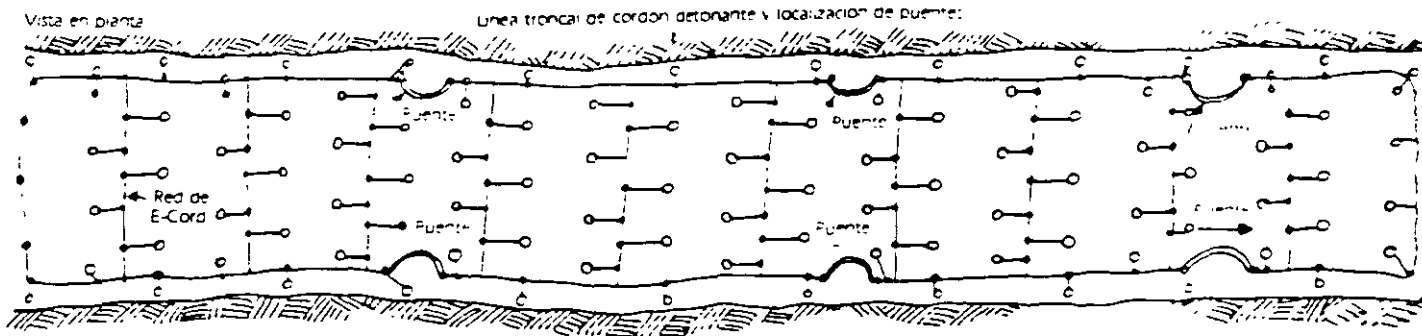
A. Conexión con "Gancho J" utilizado en un rebaje largo y angosto
